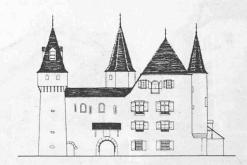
Relevé de la façade ouest du château, à la même échelle que les façades de la place. — Ech. 1:700.
